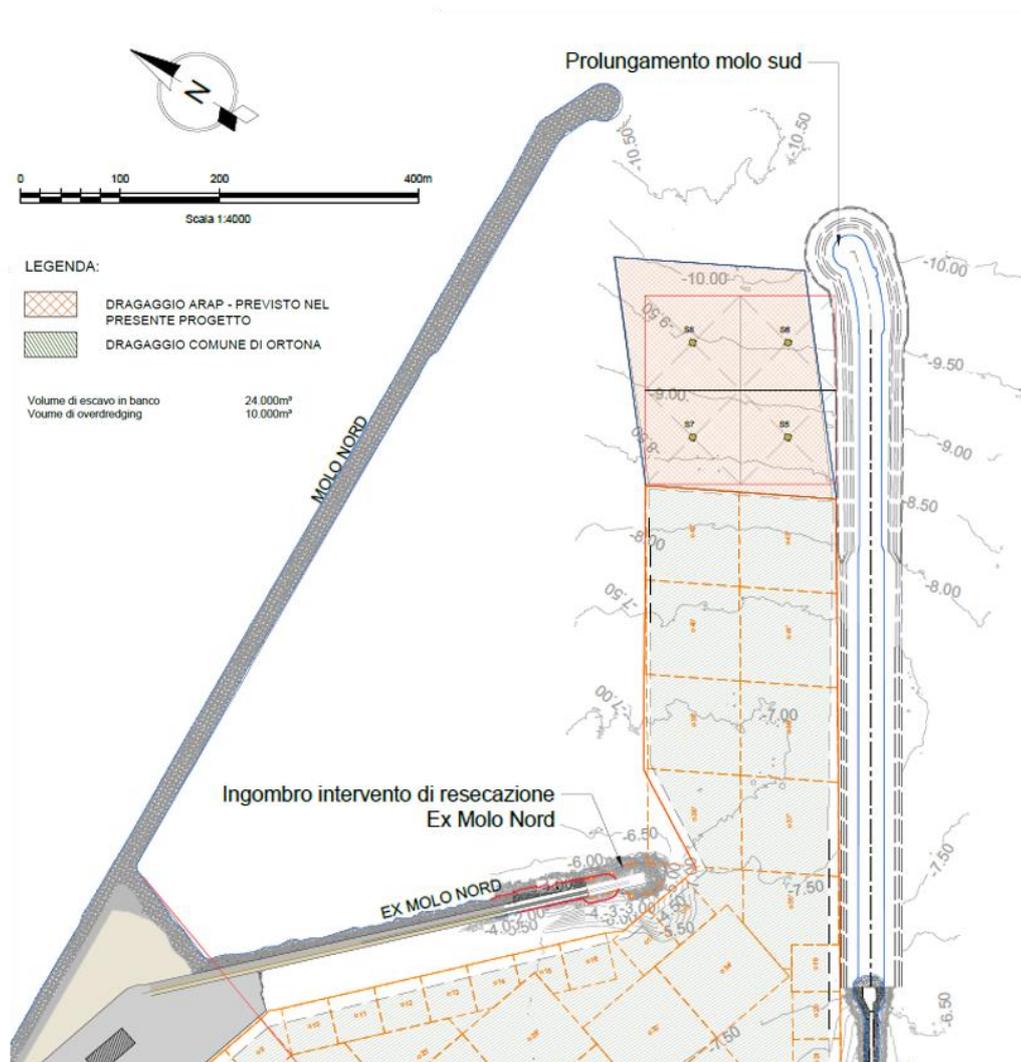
Planimetria del dragaggio del tratto terminale del canale di accesso al porto di Ortona
